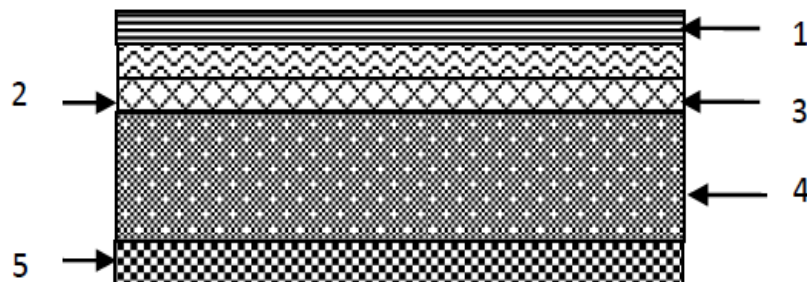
Coup transversal de plancher a dalle pleine(Balcon).
